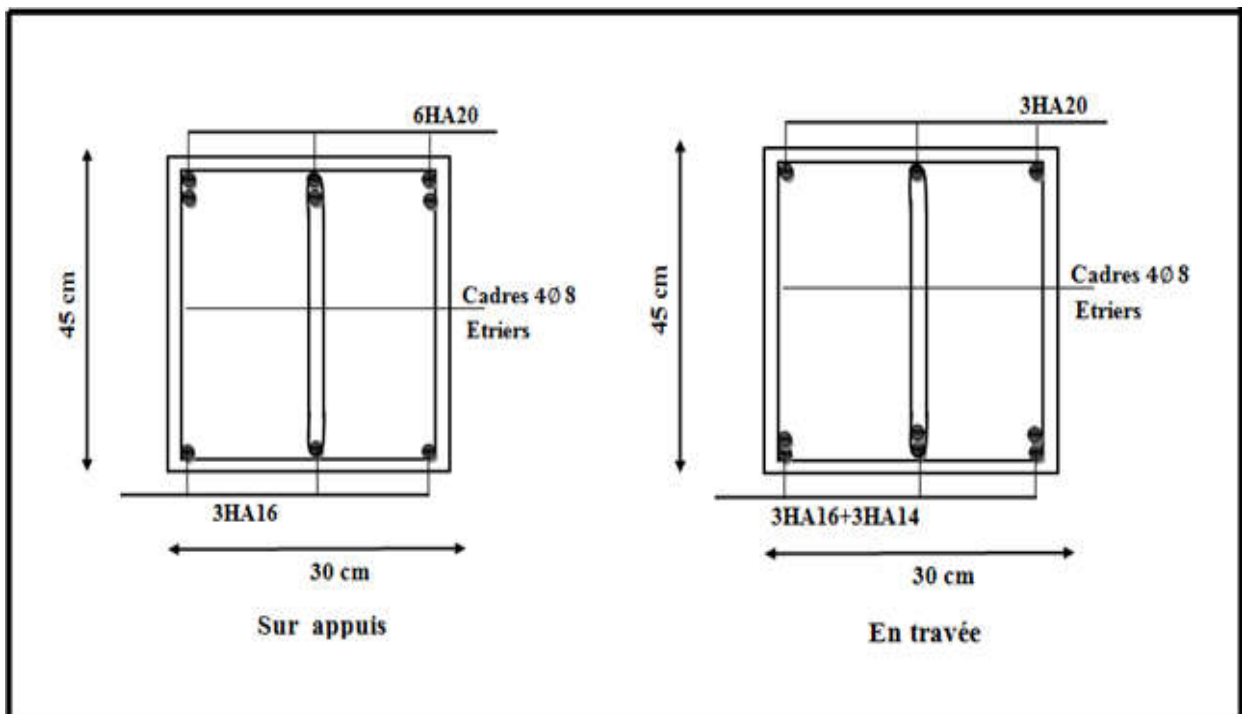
Schéma de Ferrailage des poutres secondaires.
